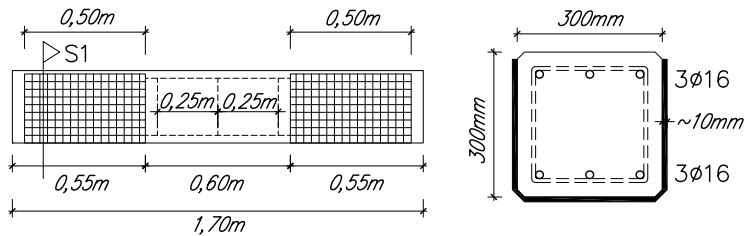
Detalle de la geometría y del refuerzo de las vigas reforzadas: ubicación del refuerzo (izquierda) y sección 1 - configuración del refuerzo en "U" (U-jacketing) (derecha).
